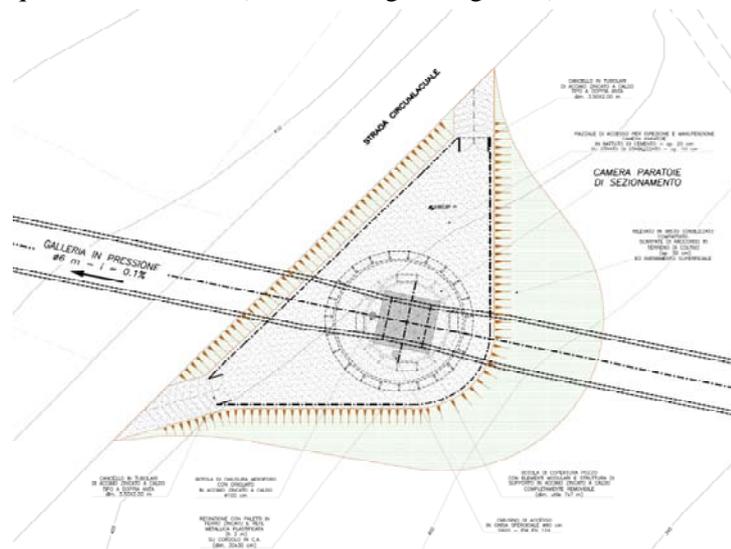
m: Stralcio Planimetrico Piazzale di Accesso al Pozzo Paratoie di Valle
